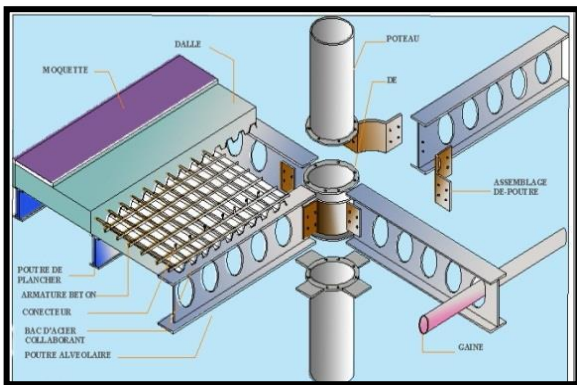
Détails de la combinaison d'une poutre alvéolaire avec un plancher collaborant
